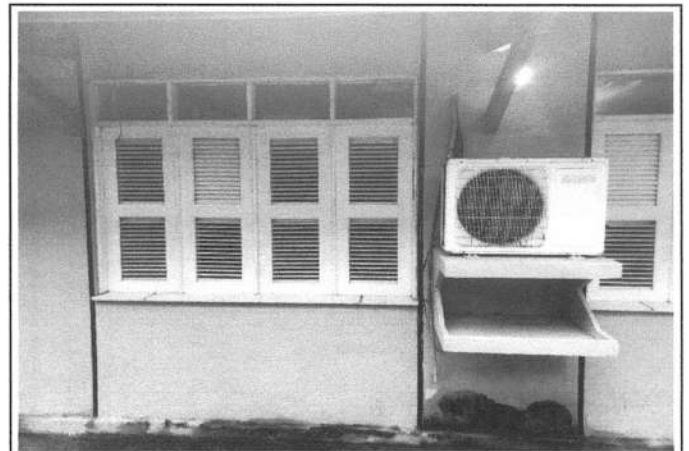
APLICAÇÃO DE TEXTURA EXTERNA
